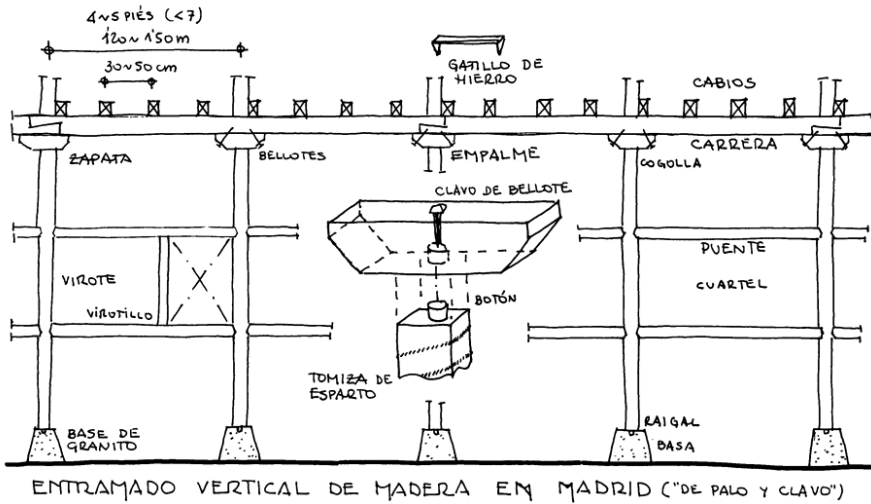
/1. Elementos de un entramado de madera tradicional
